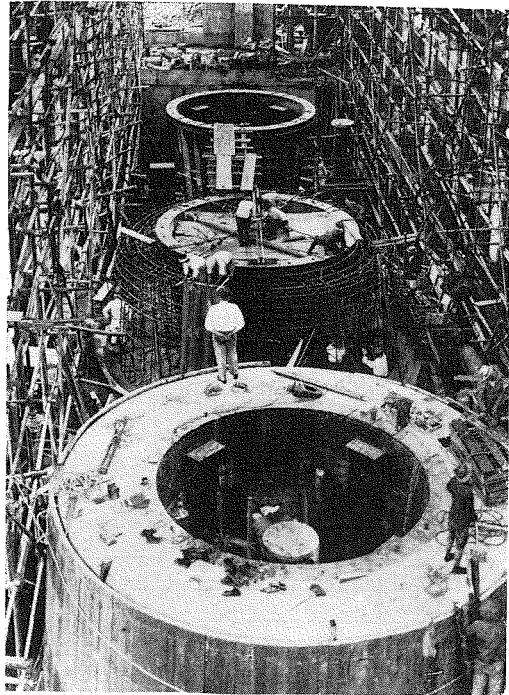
発電所内水車据付の光景（3）第一ランナ一据付、コンクリートバレル施工、第二コンクリートバレル鋼筋組立中、第三バレルランナー据付完了、建家は三段目のコンクリート施工済。
